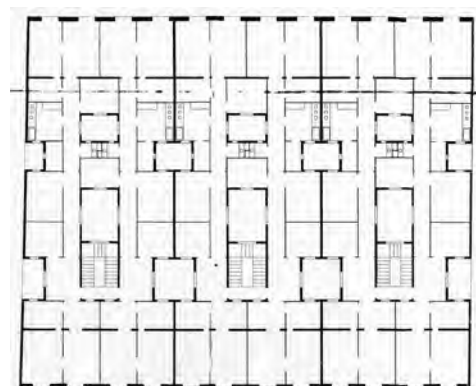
Josep Vilaseca. Planta de edificio de Viviendas en la C/ Mallorca, Barcelona 1891.
